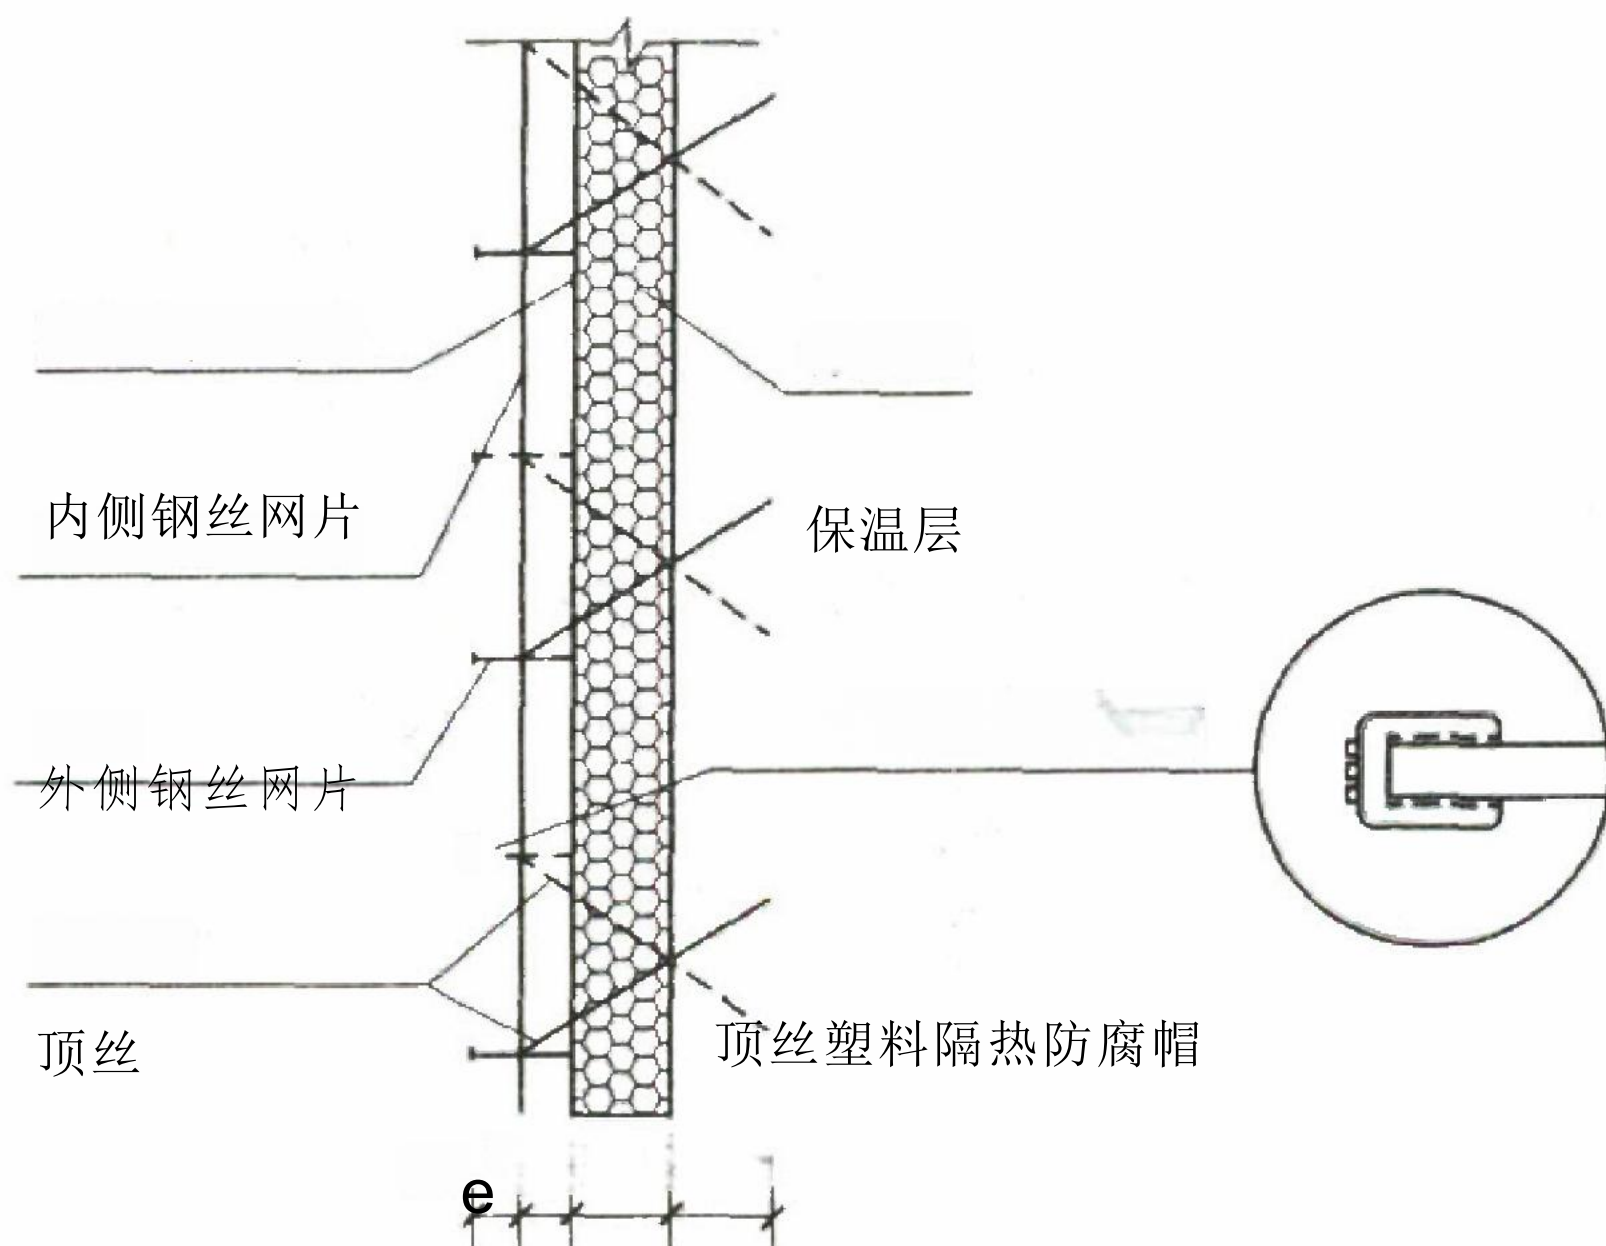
焊接钢丝网架保温板构造示意图 (单位: mm)
